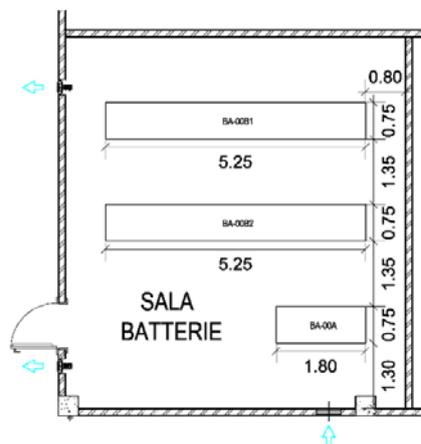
Sala batterie – Layout (21\_08\_PE\_TP04)
